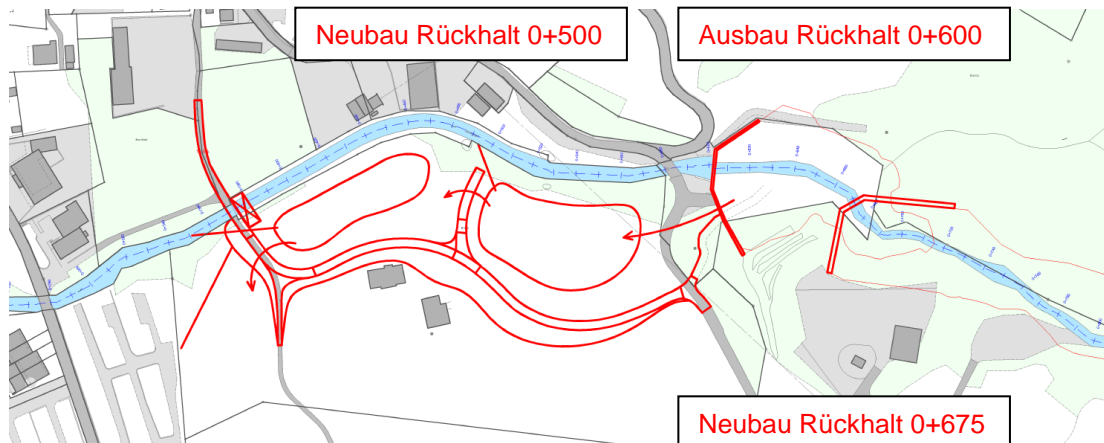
Variante 10, Ausbau des bestehenden Rückhalts 0+600 inkl. Überleitung, Neubau Rückhalt 0+675, Neubau Rückhalt 0+500
